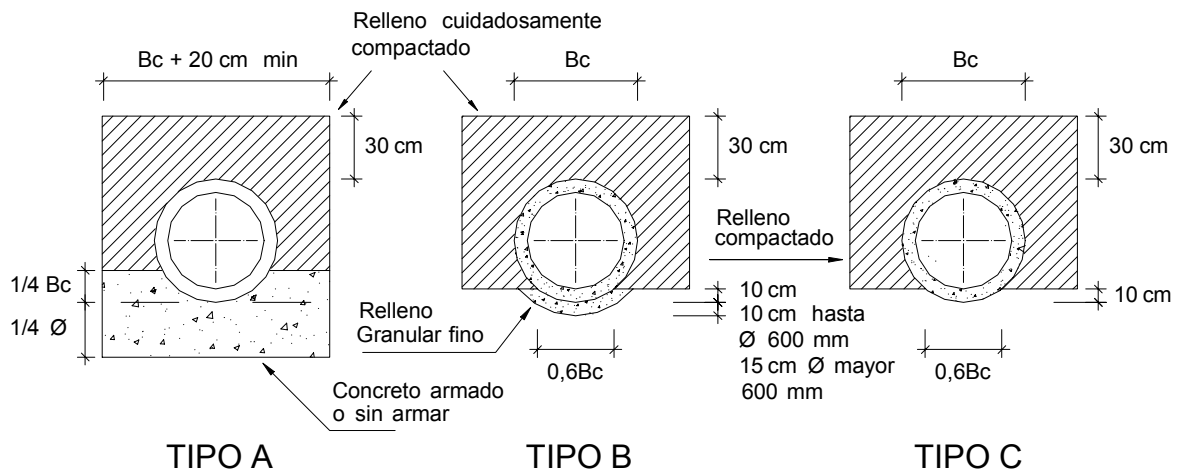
Tipos de apoyo de colectores (INOS; Normas e instructivos para el proyecto de alcantarillados, 1989).
